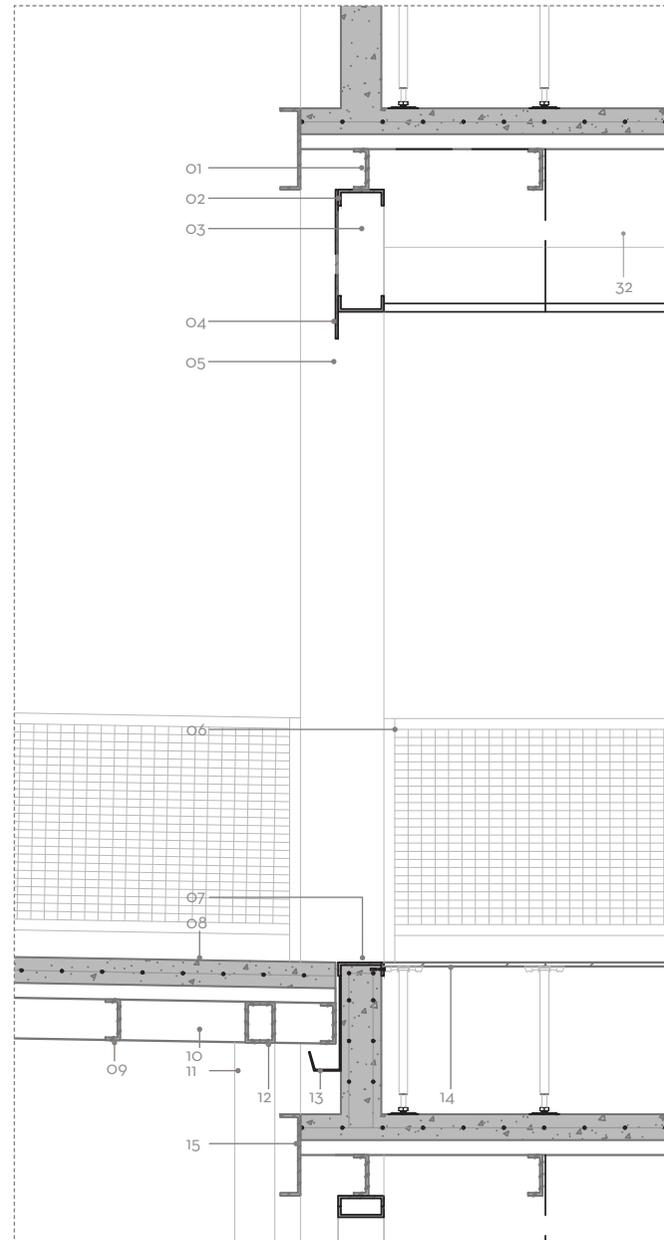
Det_01 Escantillón junta longitudinal losa de vestibulo exterior y losa de piso técnico
